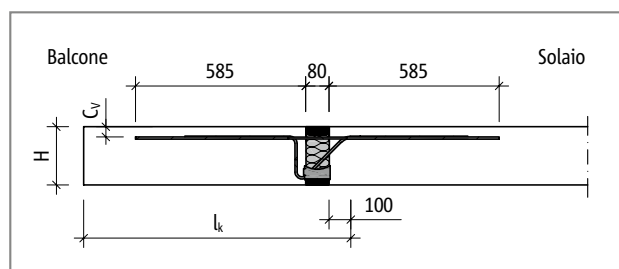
Schöck Isokorb® T tipo KL-M1 - M7: sistema statico
